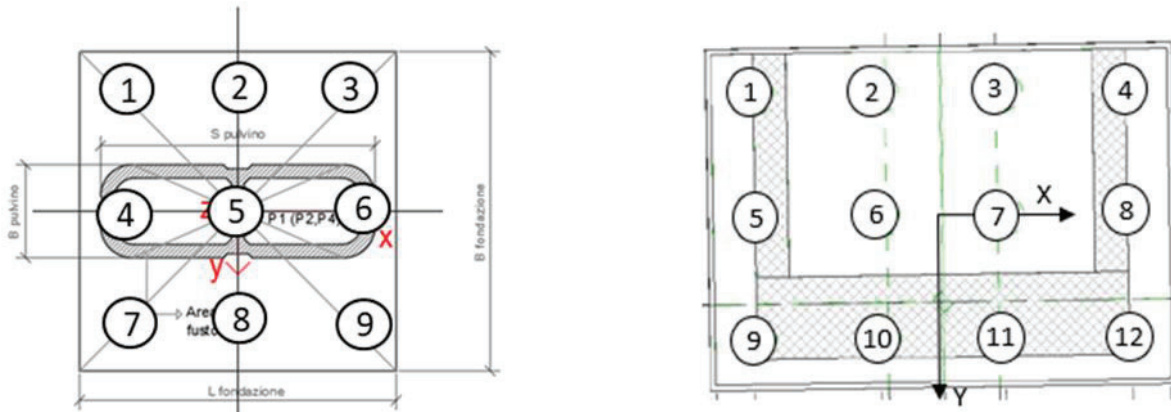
Sistema di riferimento per le fondazioni delle pile e delle spalle con indicazione della numerazione dei pali.
